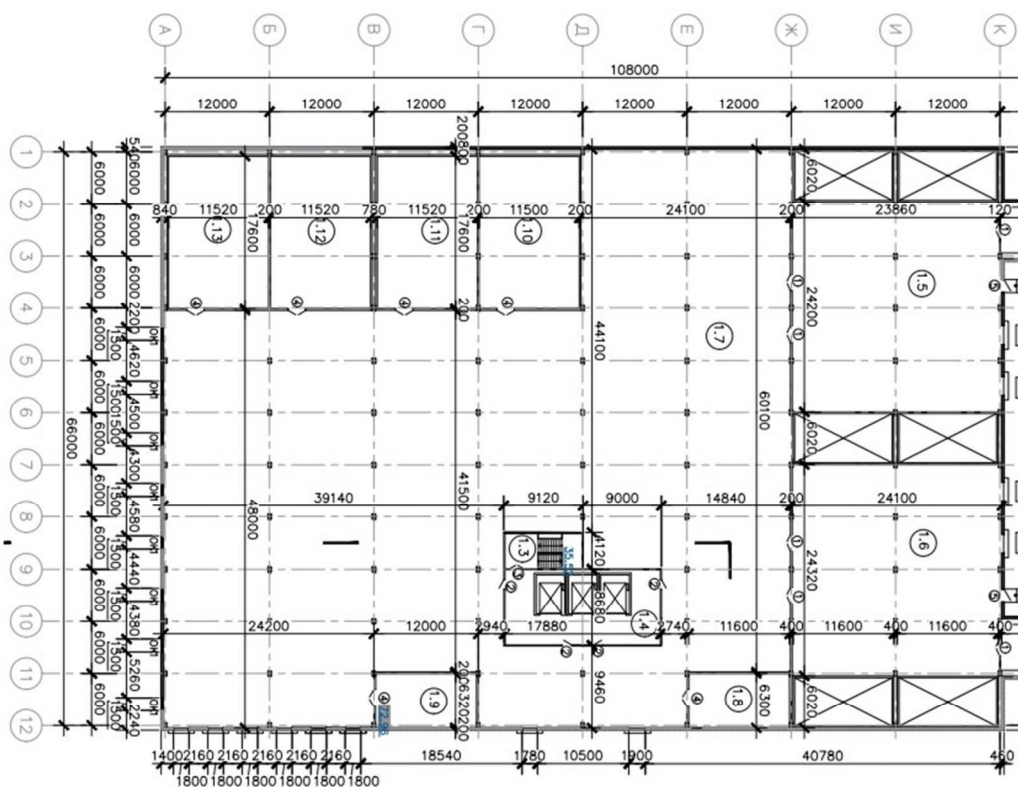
Рассматриваемая плита перекрытия на отм. +4,400
